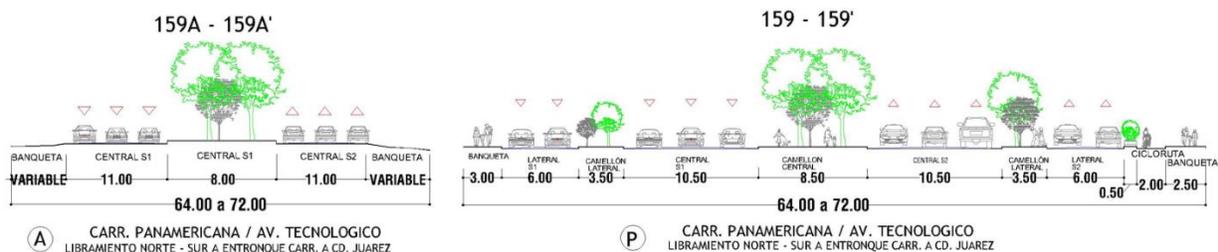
Sección vial actual. Fuente PDU 2040 vigente.
